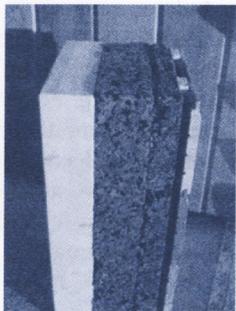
maquette d'une paroi verticale de la Maison Z.E.N
